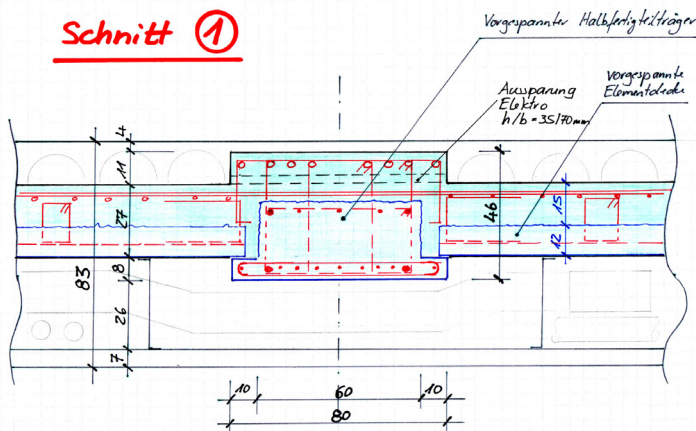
Unterzugquerschnitt der Halbfertigteildecke
